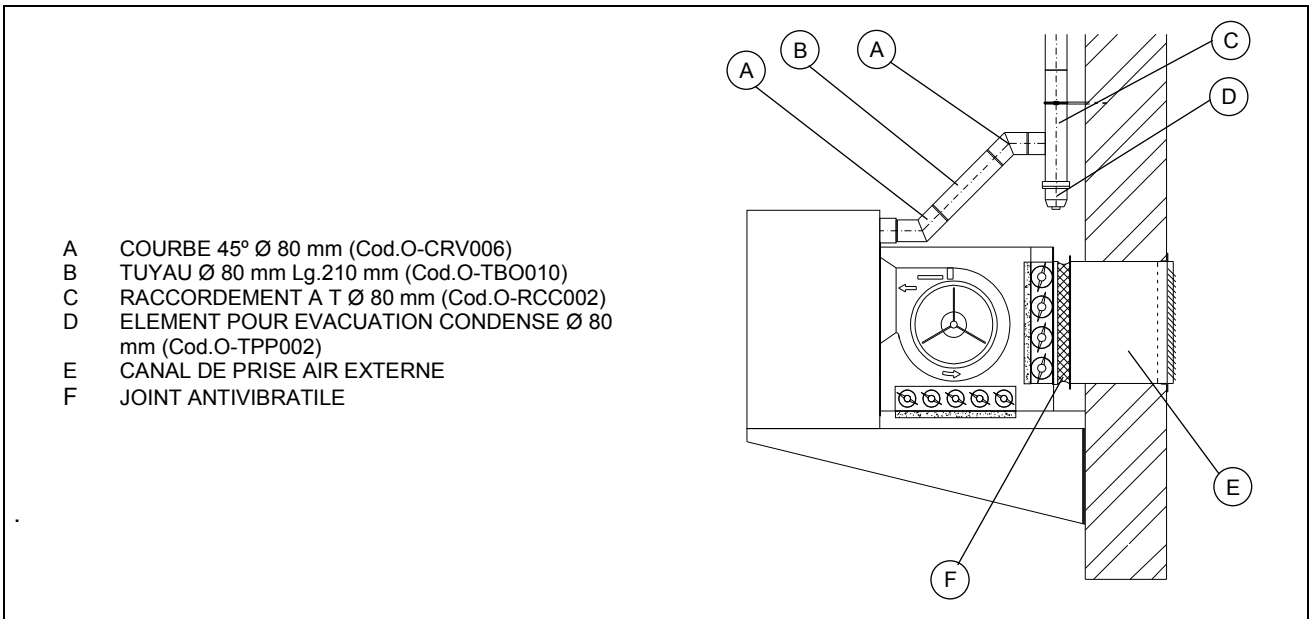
INSTALLATION CONDUIT EVACUATION DES CONDENSATS F1 CM
